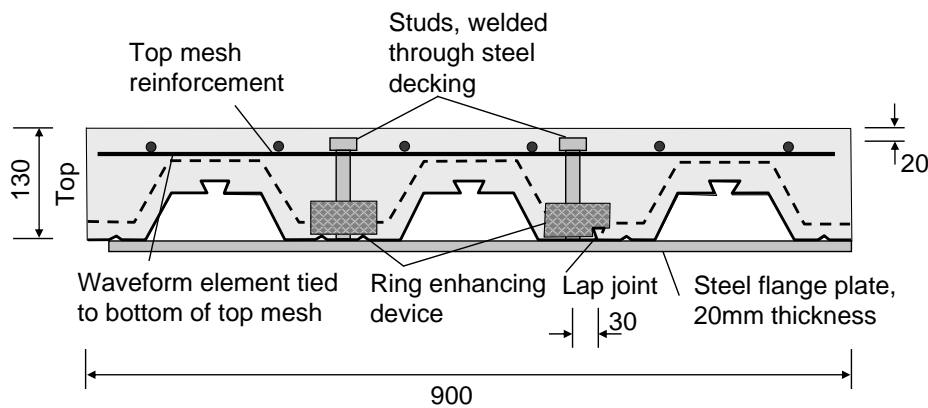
Schematische Darstellung eines Versuchskörpers aus Ernst [37] mit zusätzlicher Sickenbewehrung und Kopfbolzenringen
